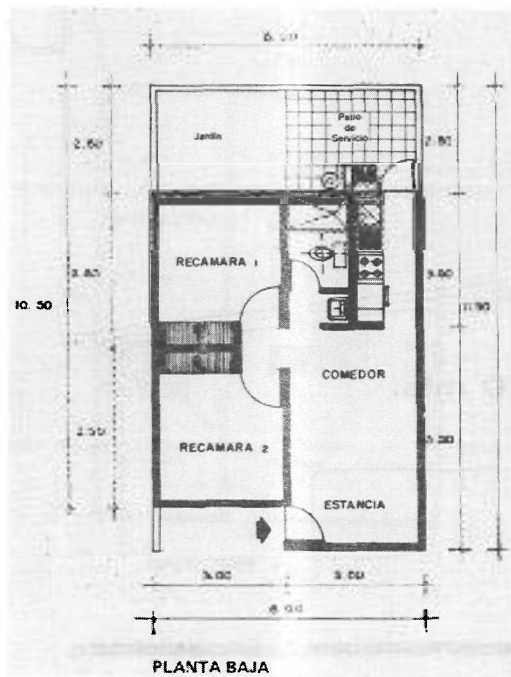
Propuesta arquitectónica tipo 1 [1]
